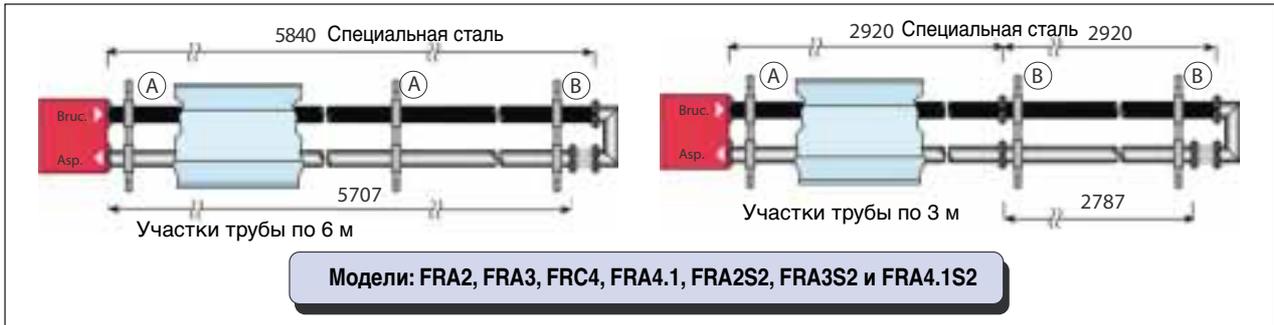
Схема сборки нагревательных панелей длиной 6 метров
